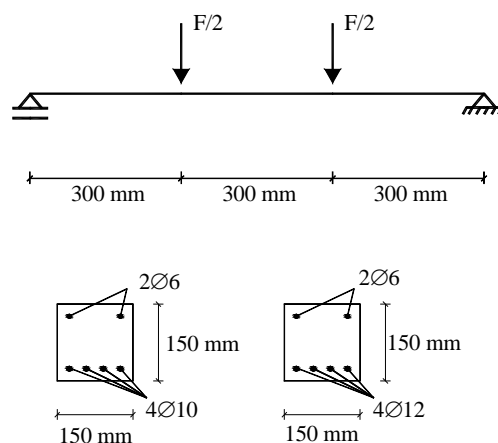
Modelo estrutural e as secções transversais das vigas da série B.
